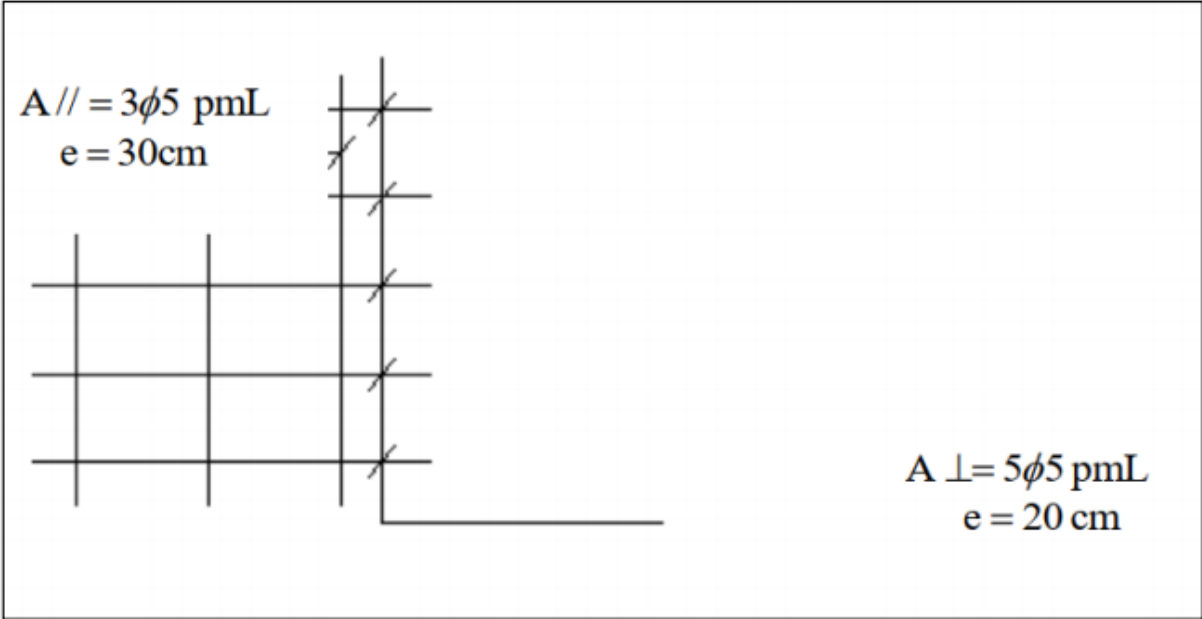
Schéma du ferrailage de la dalle mince.
